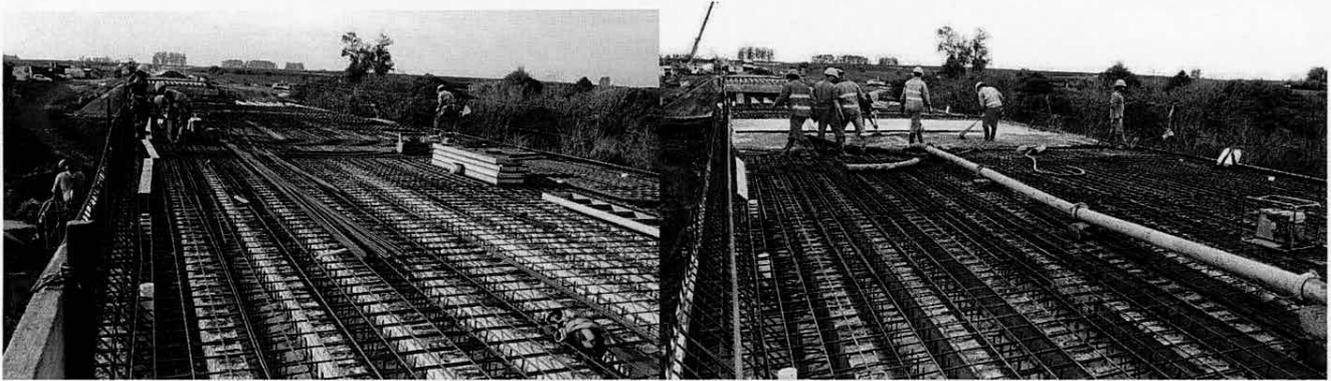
, 7 y 8 – Armadura y llenado en sitio del tablero
